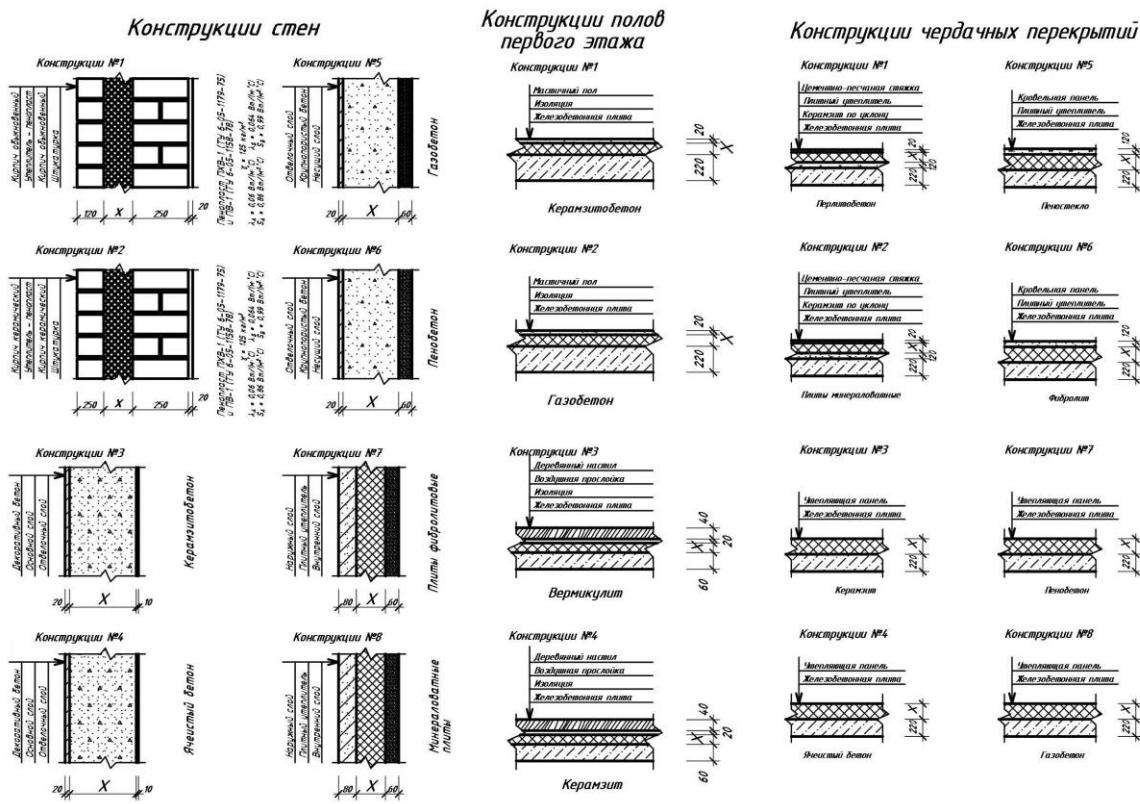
Конструкции ограждения (стен, полов первого этажа, чердачных перекрытий)
